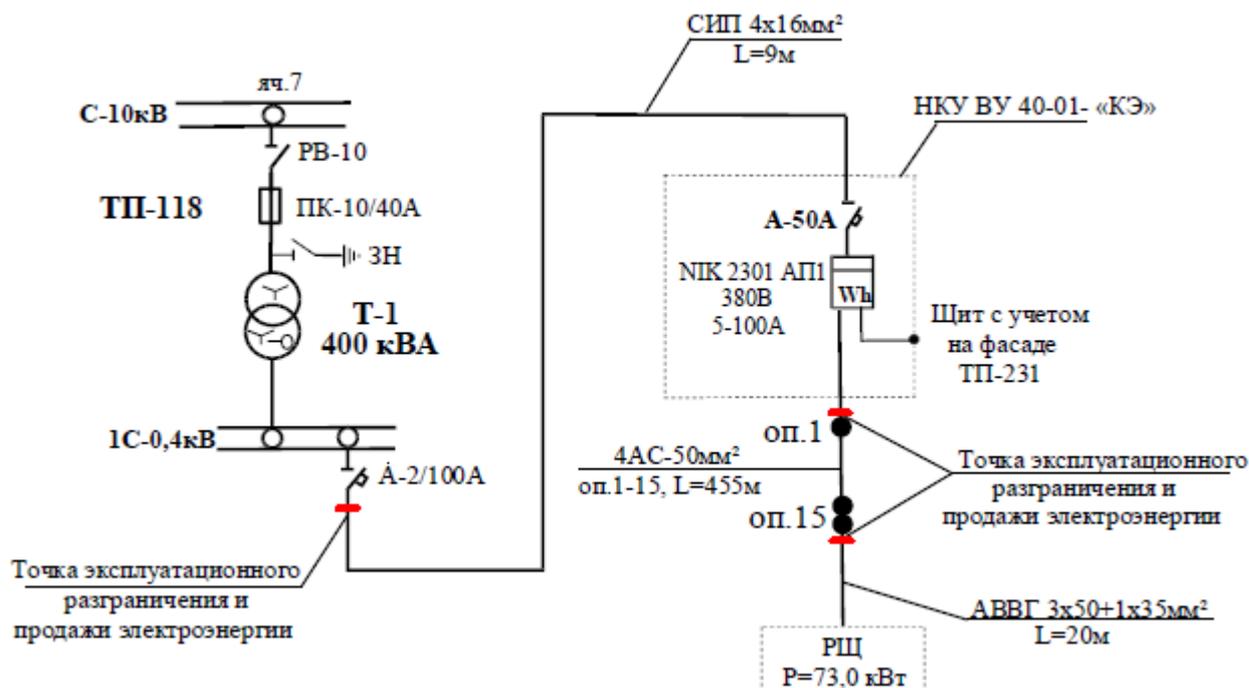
Схема электроснабжения КОС с.Мещерское
